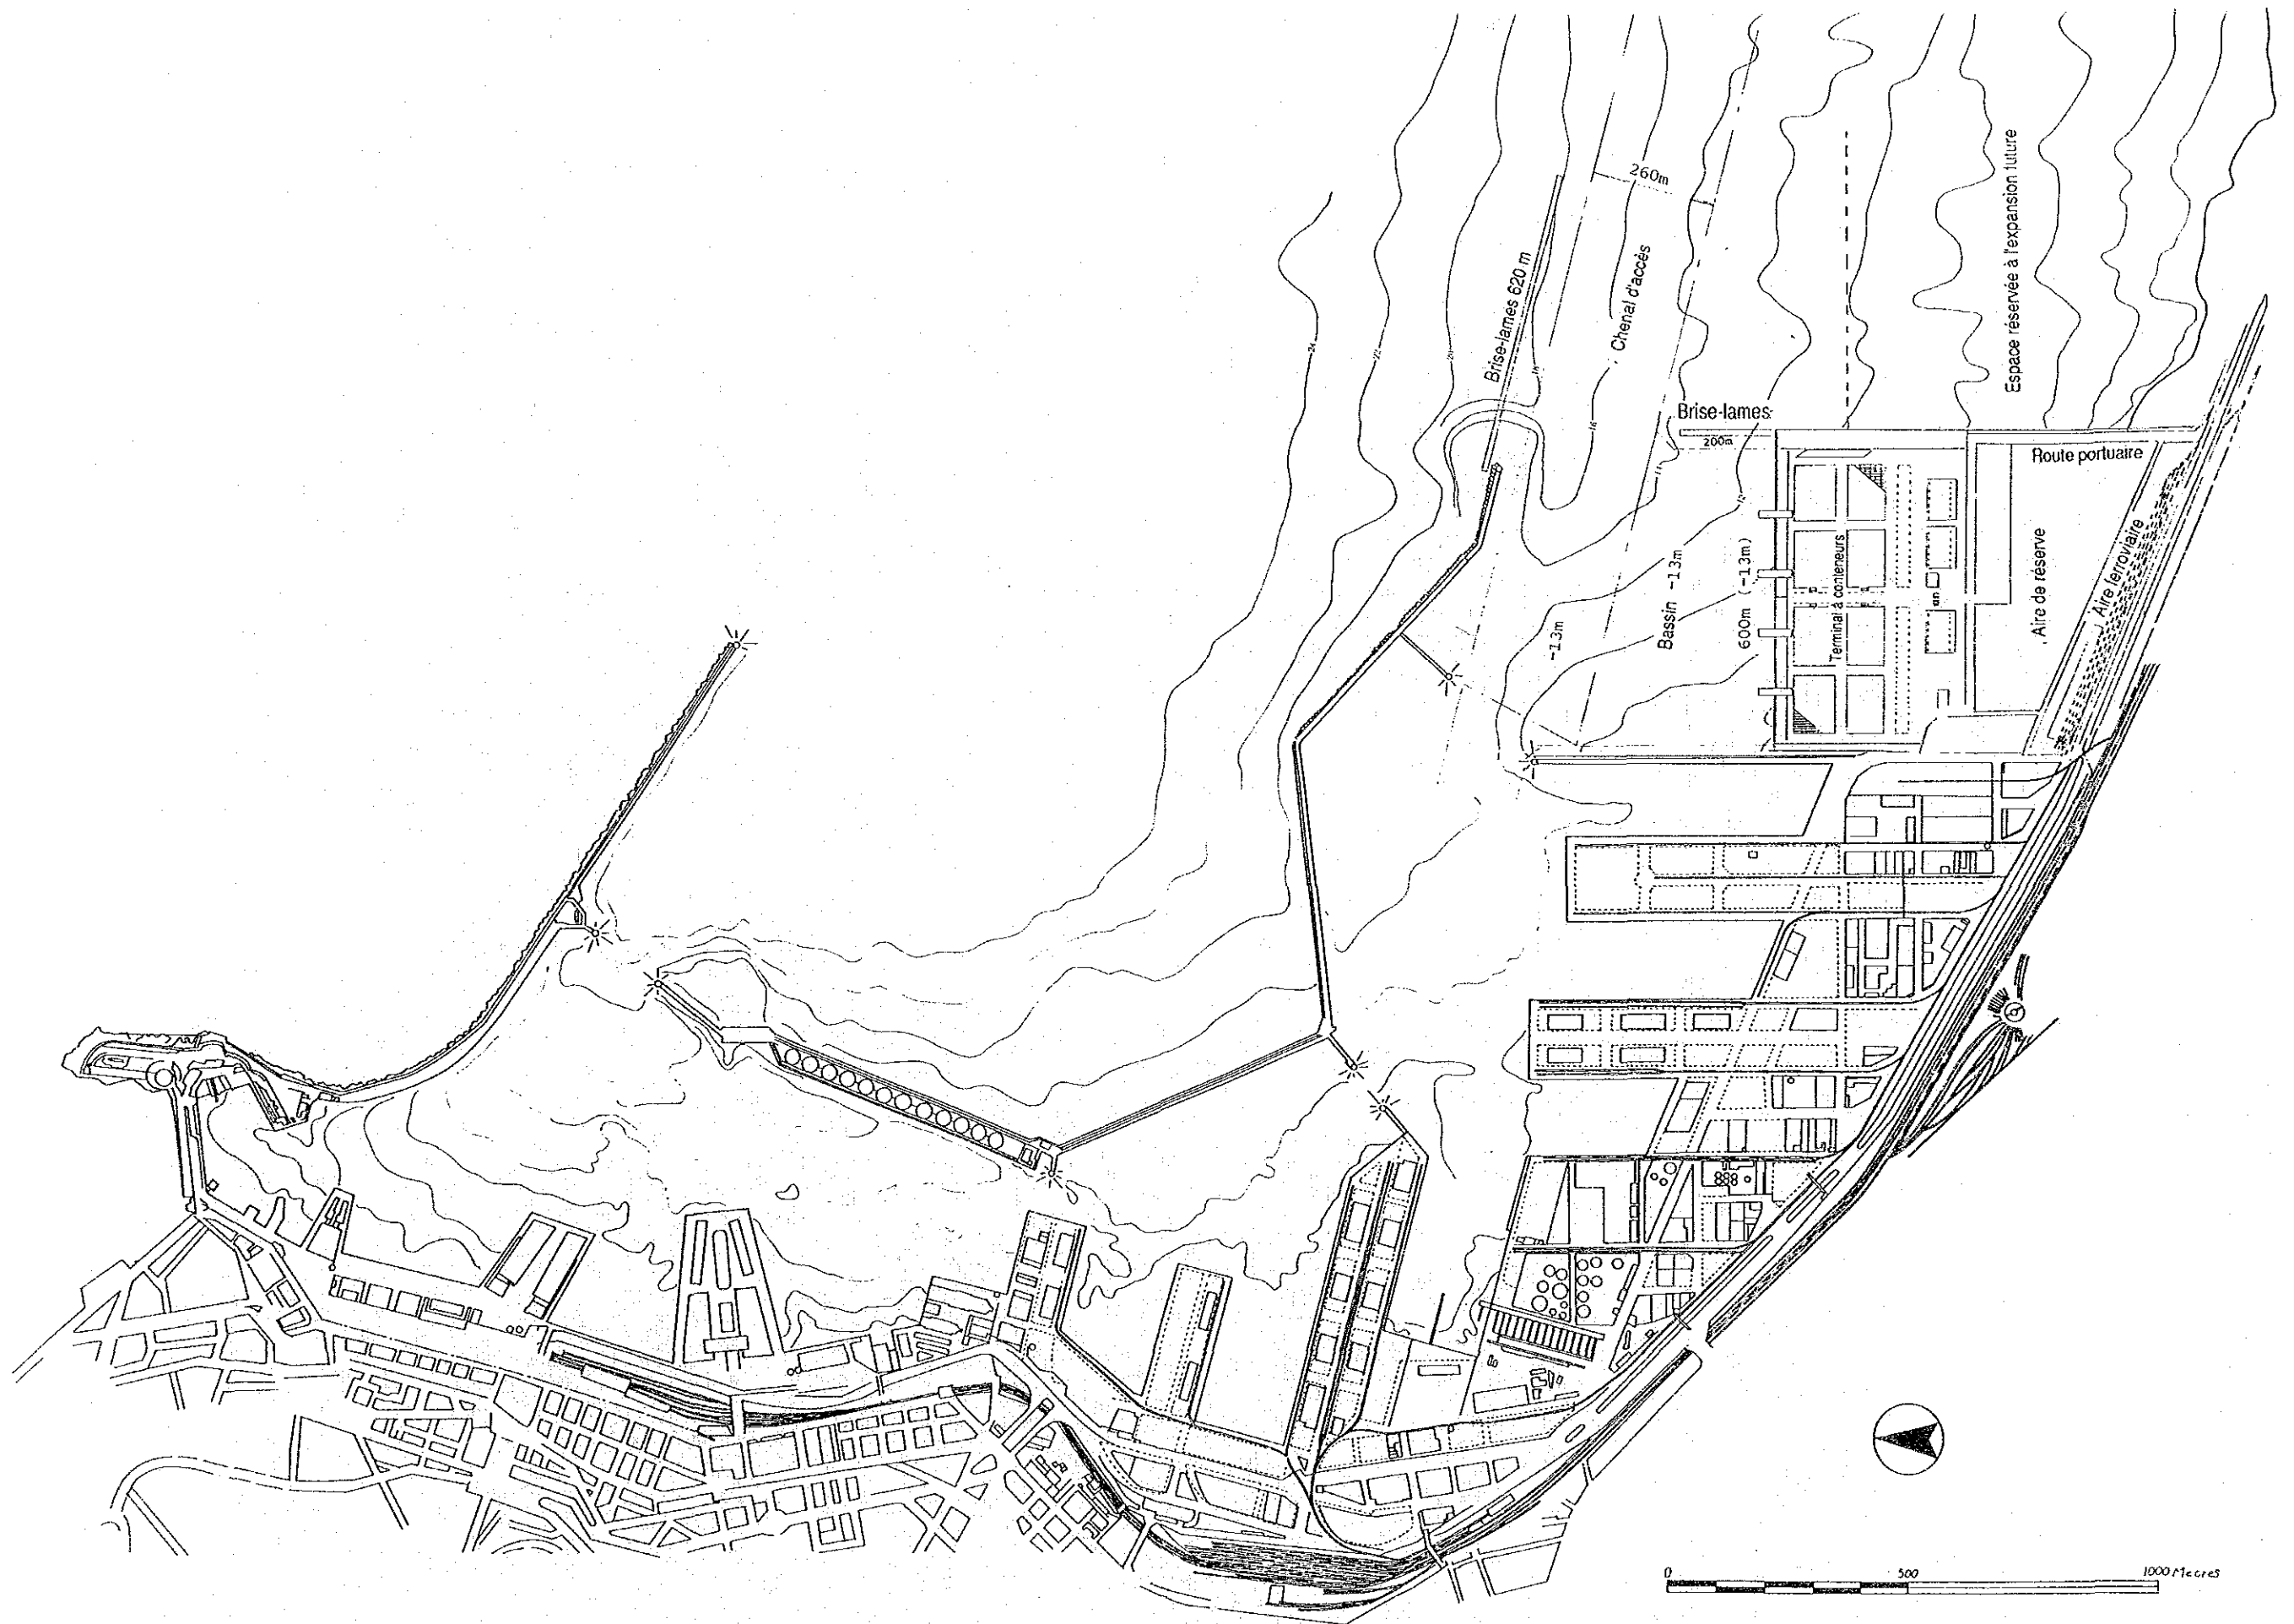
Plans de développement alternatifs pour le Terminal-2 (cas 1)
